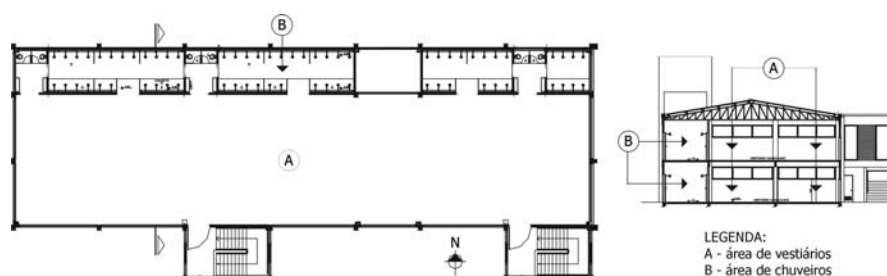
planta do segundo pavimento e corte transversal do edifício vestiários, sem escala.
